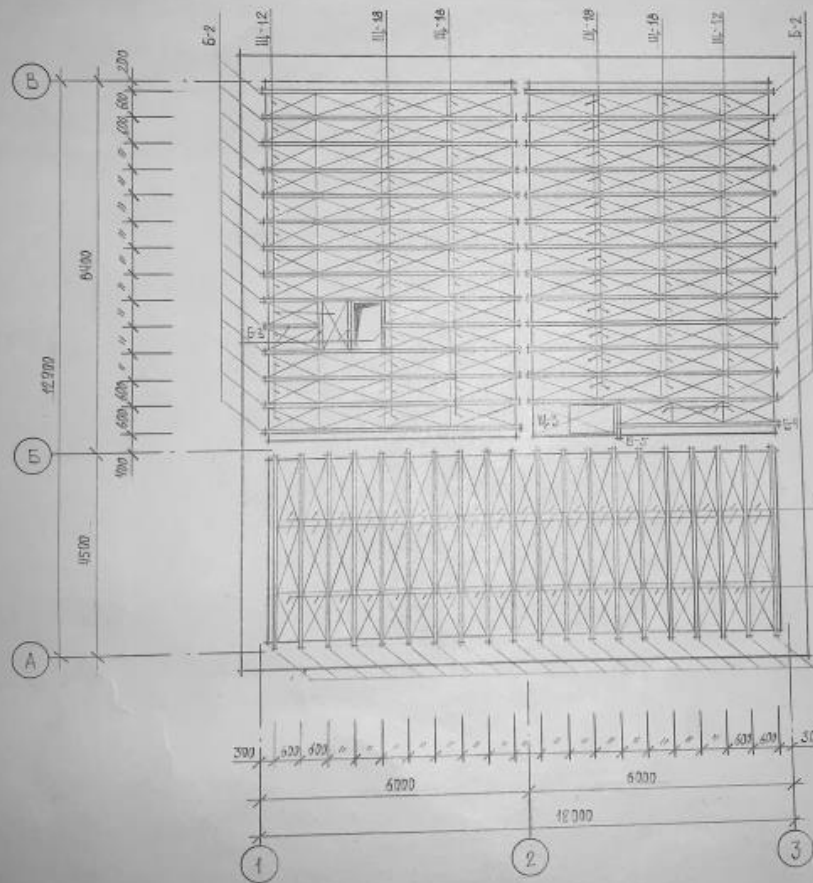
Перекрытия чердачные, над проездами и подвалами
